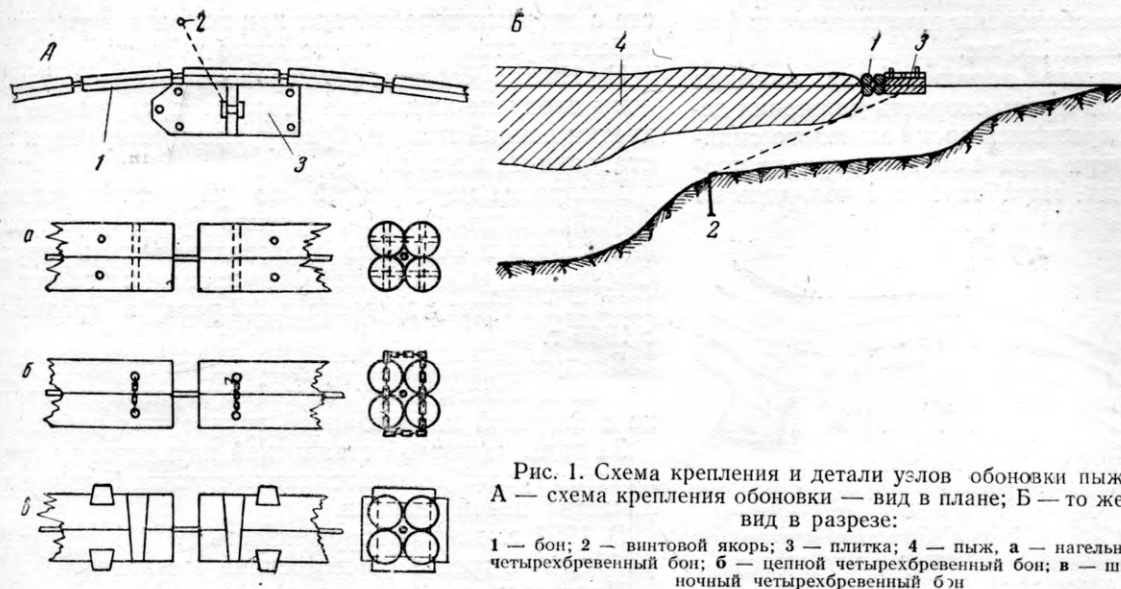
Схема крепления и детали узлов обоновки пыжа. А — схема крепления обоновки — вид в плане; Б — то же — вид в разрезе:
